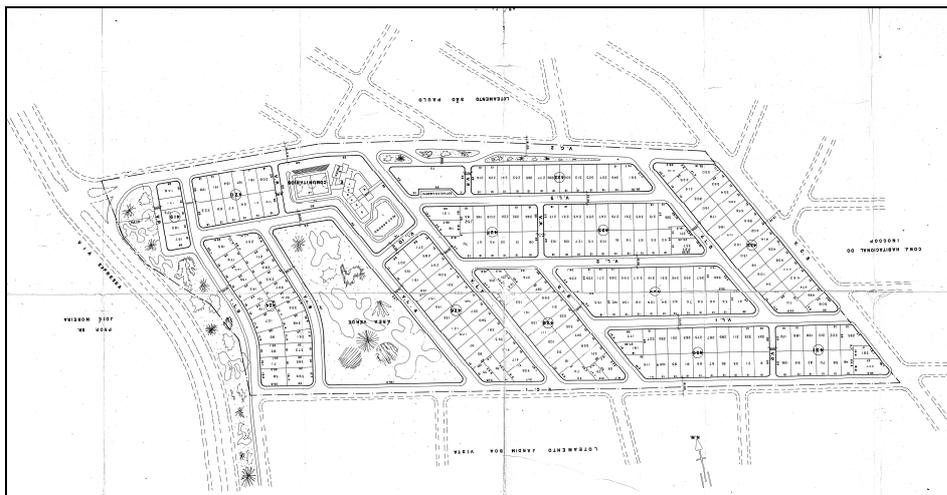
Planta do loteamento Itubiara C (1980) no bairro de Anatólia.
